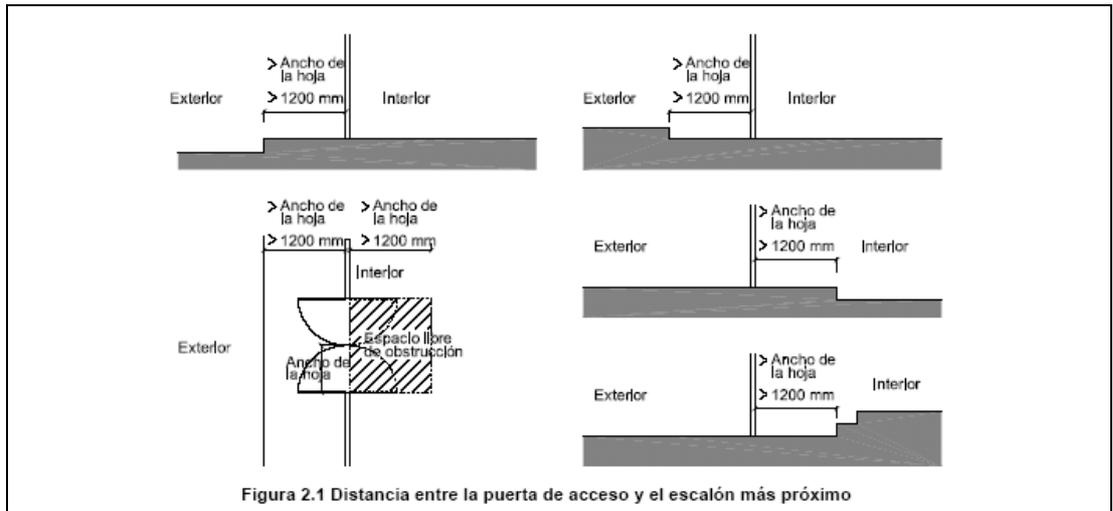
Distancia entre la puerta de acceso y el escalón más próximo
